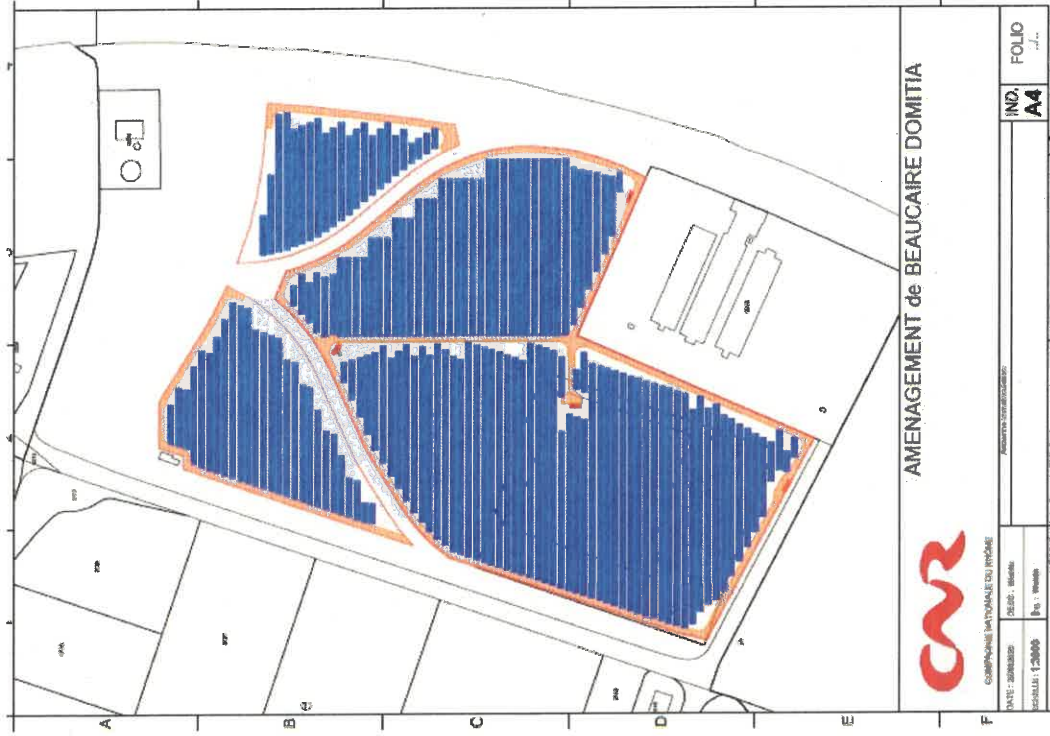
Plan de masse de la variante 0 (juin 2020)
